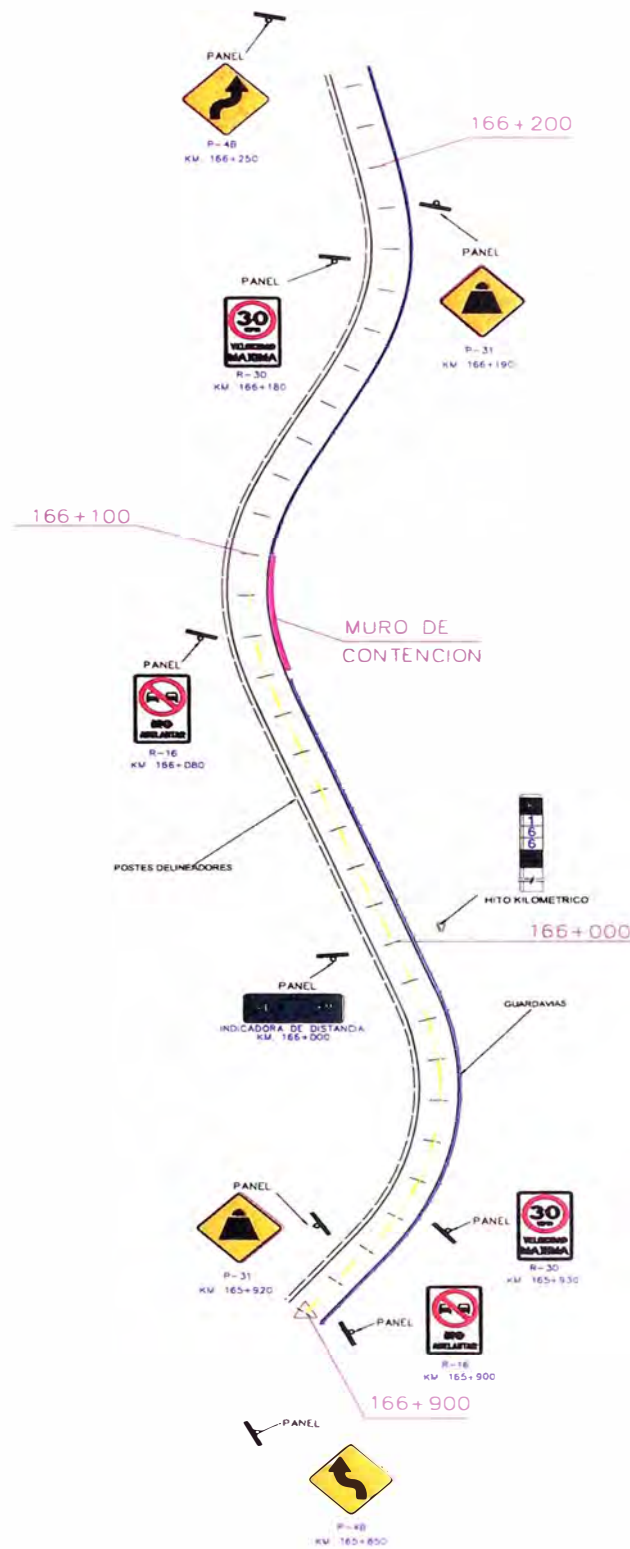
Plano de ubicación de señales verticales, marcas en el pavimento y delineadores reflectivos.
